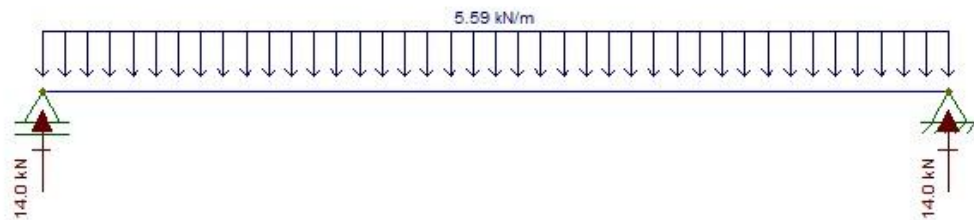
Esquema estrutural de viga biapoiada, representando as reações da laje de piso.
